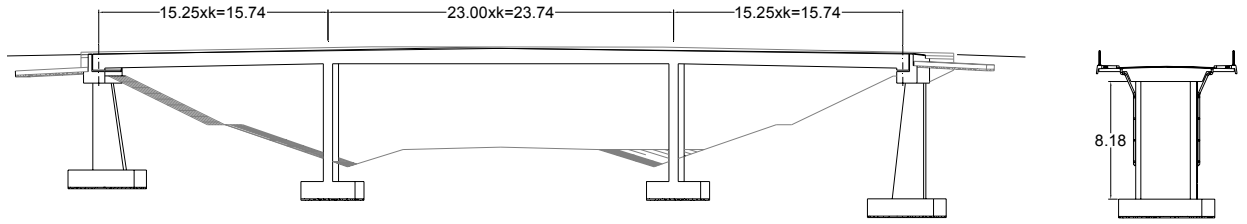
Corte Longitudinal e Transversal de PS12E
